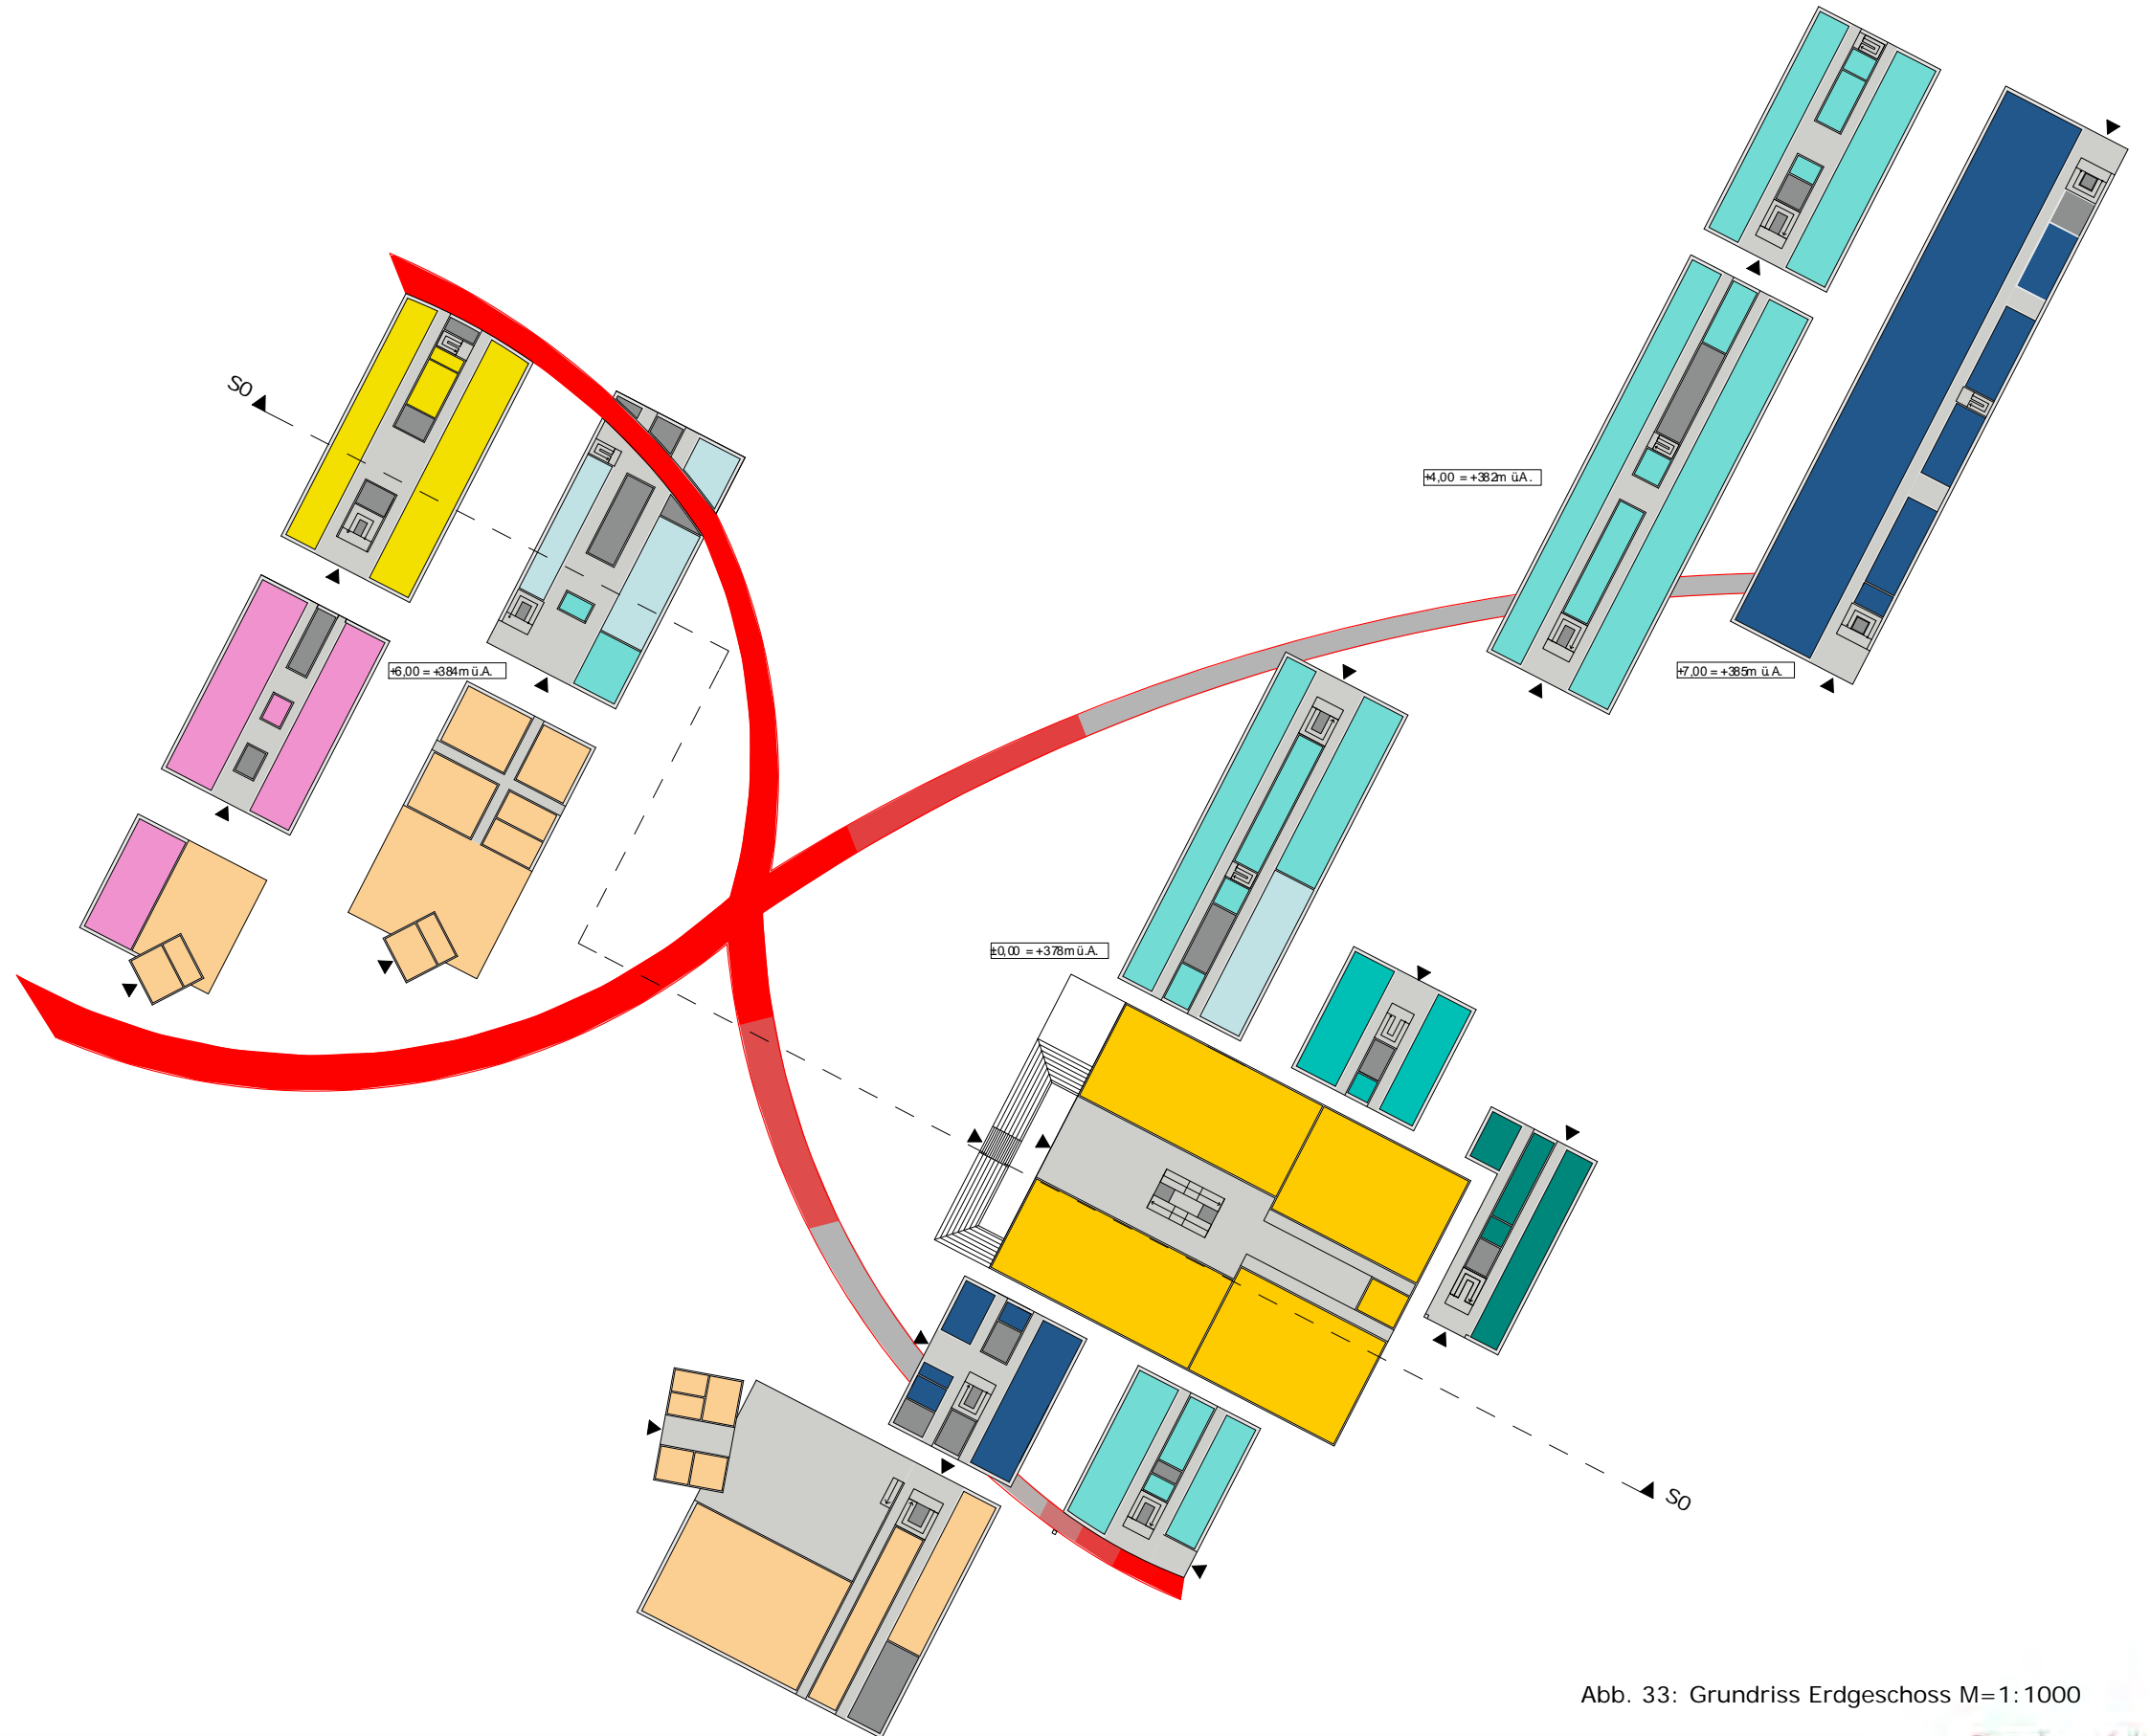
Grundriss Erdgeschoss M=1:1000
